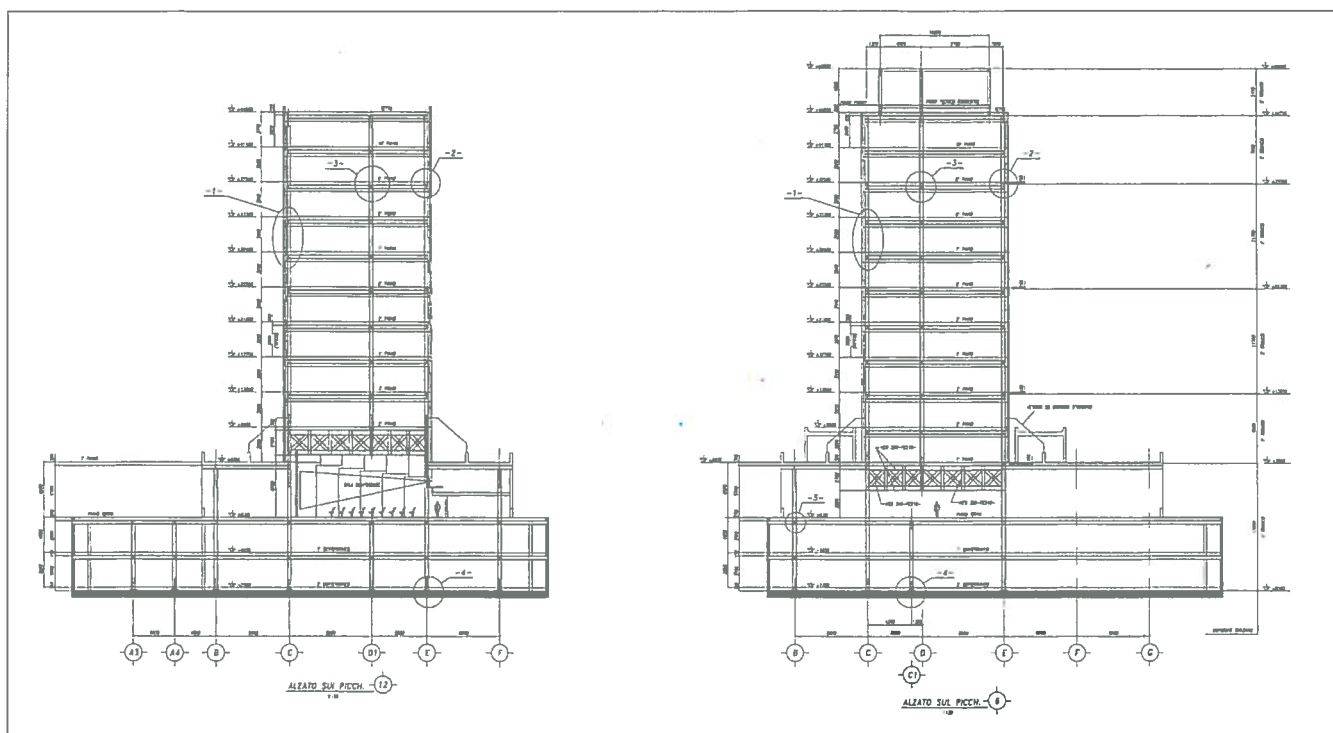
Sezione verticale trasversale dell'edificio in corrispondenza della hall.
